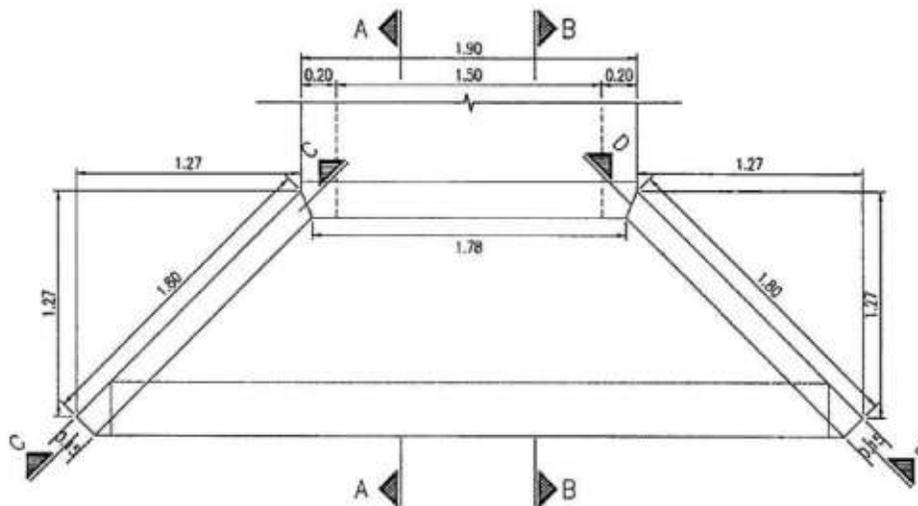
Planta de cabezal del box culvert de 1.50x1.50m del Tramo vial San José de Oriente – El Rincón.
